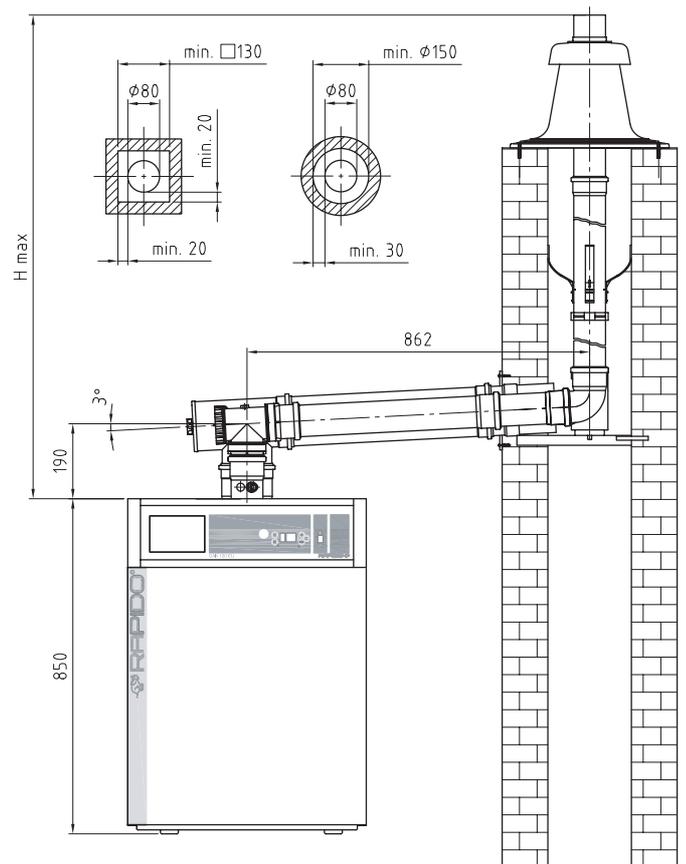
Raumluftunabhängige Abgasführung im Schacht
